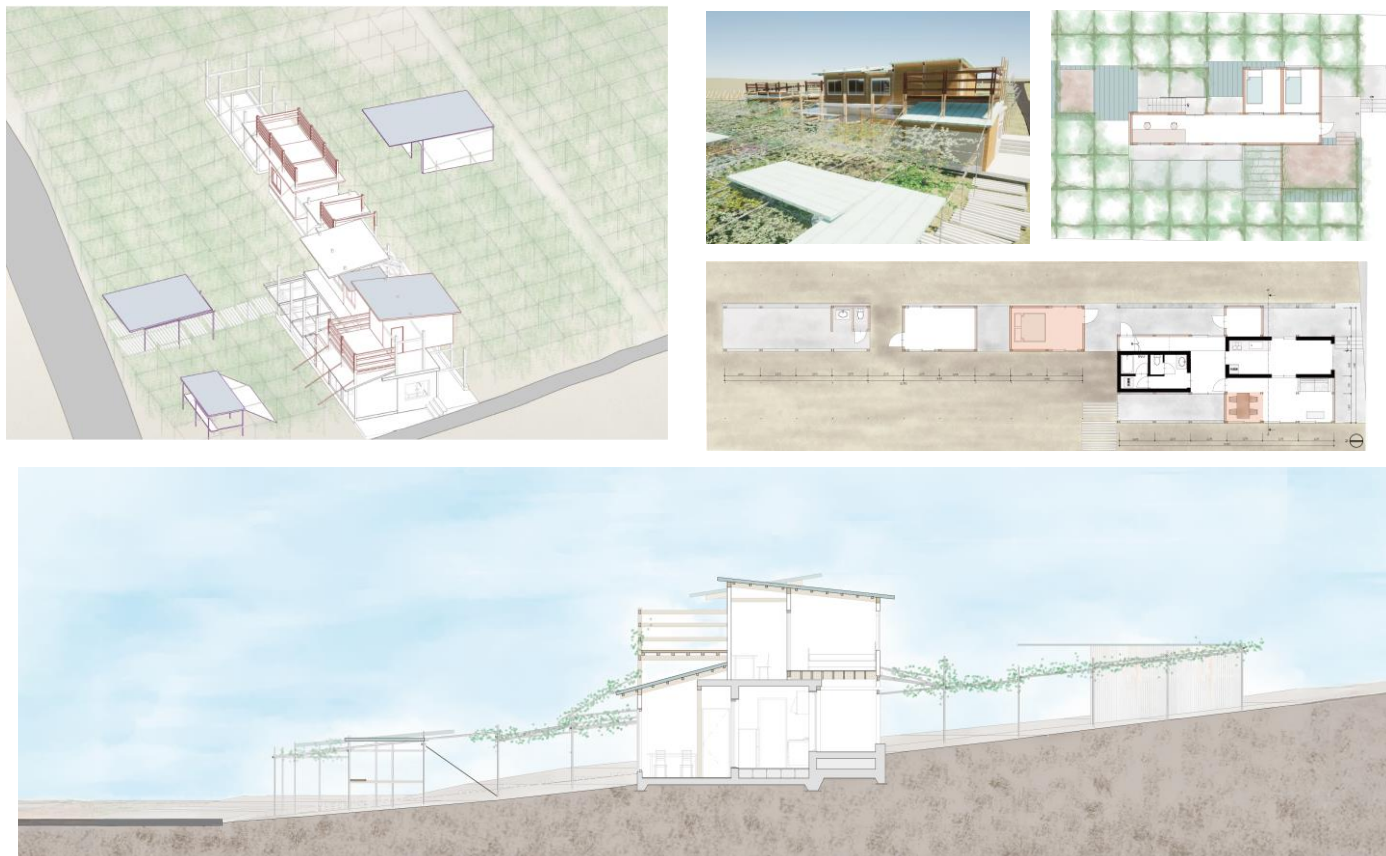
STEP 3 アイソメ図 1F 平面図 2F 平面図 断面図 パース
